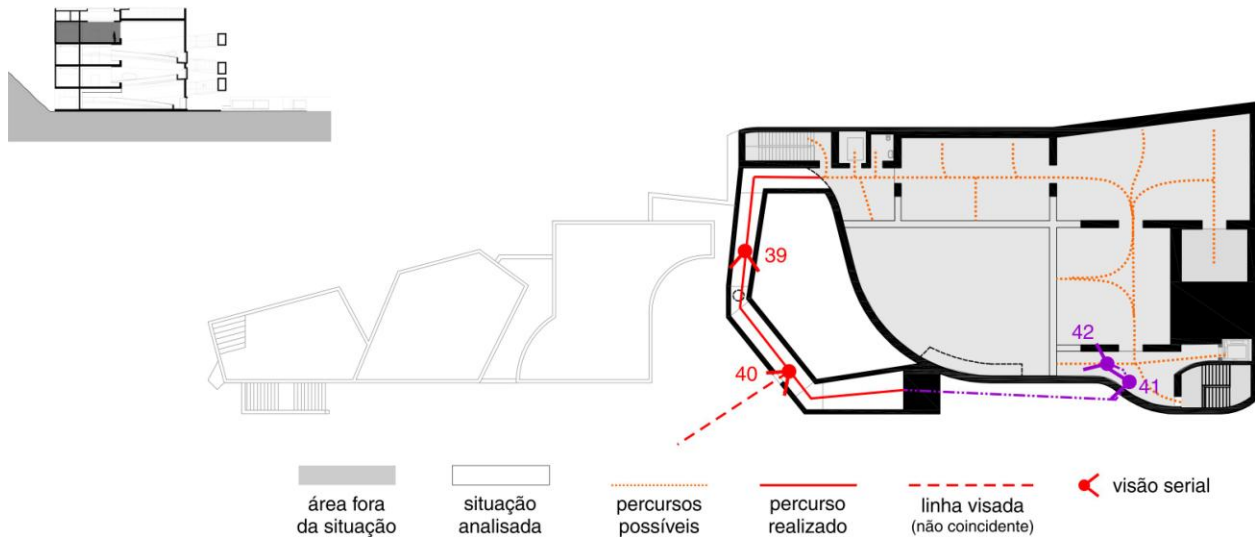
| FIC – Planta Quarto Pavimento | Desenho da Autora
